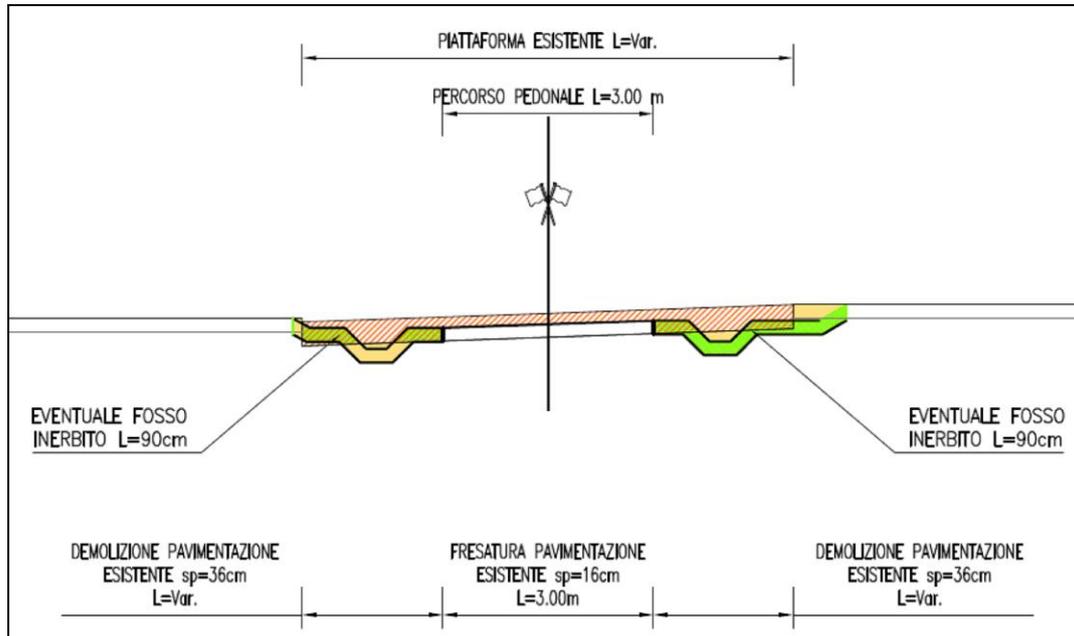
Schema demolizione pacchetto di pavimentazione flessibile
